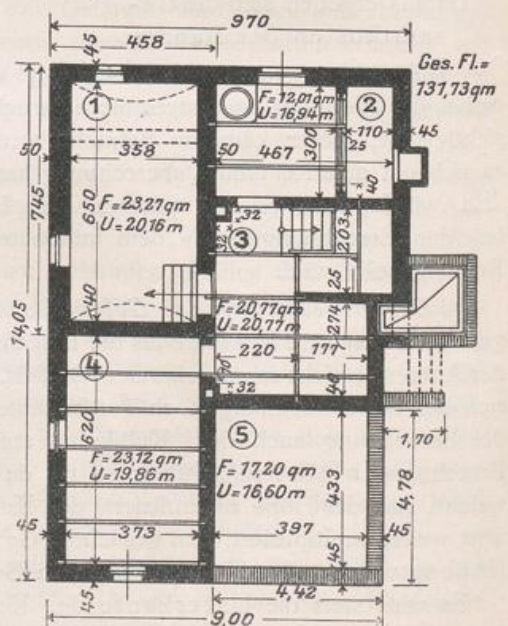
Grundriß des Kellers. M. 1 : 200.
